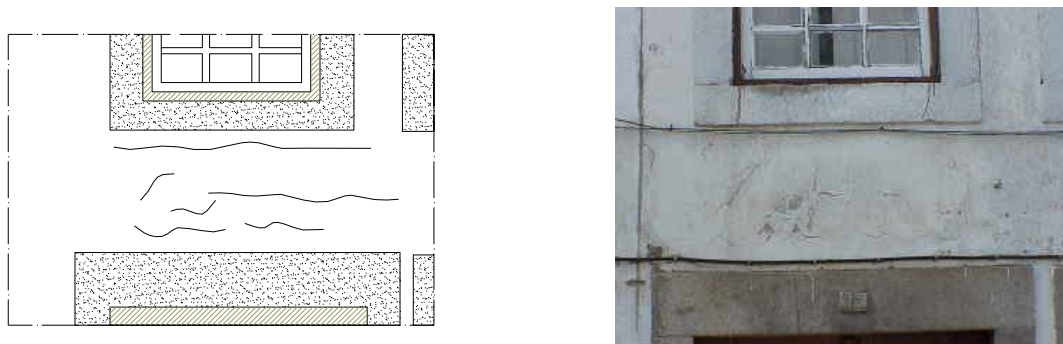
Exemplo de fissuração predominantemente horizontal
